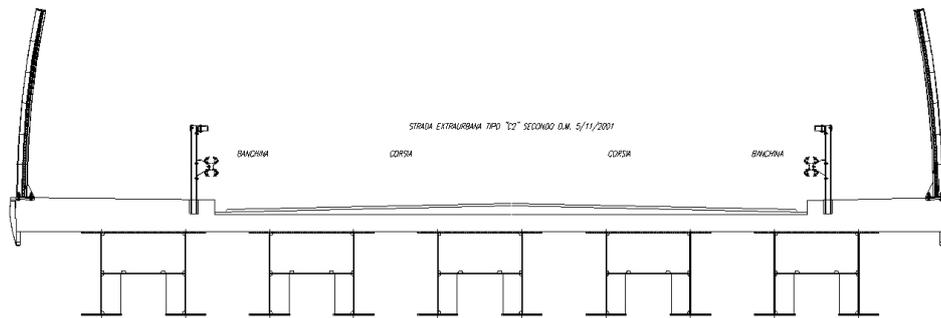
Sezione trasversale del nuovo sovrappasso n. 69
